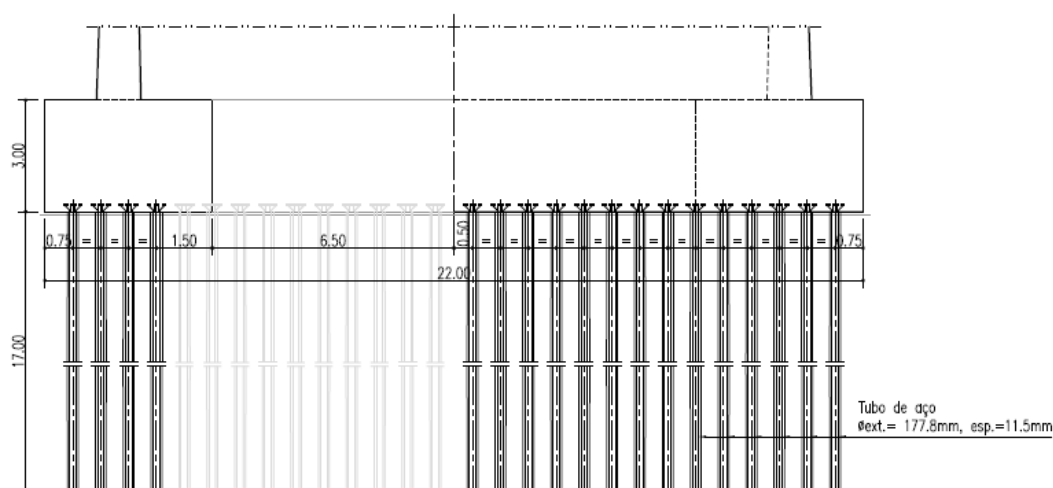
Corte transversal A – A' da fundação do pilar P18
